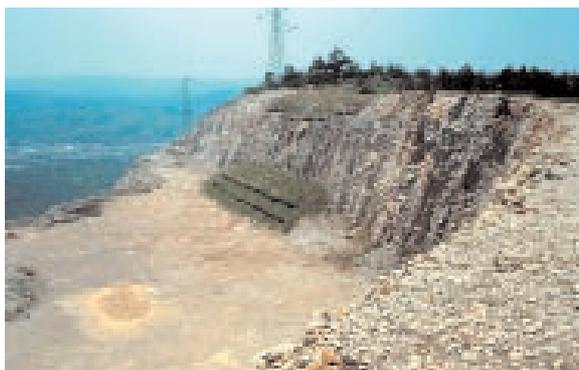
Cava Scoria, lavori di recupero con rilevati rivegetati, campione di prova, dicembre 1984
